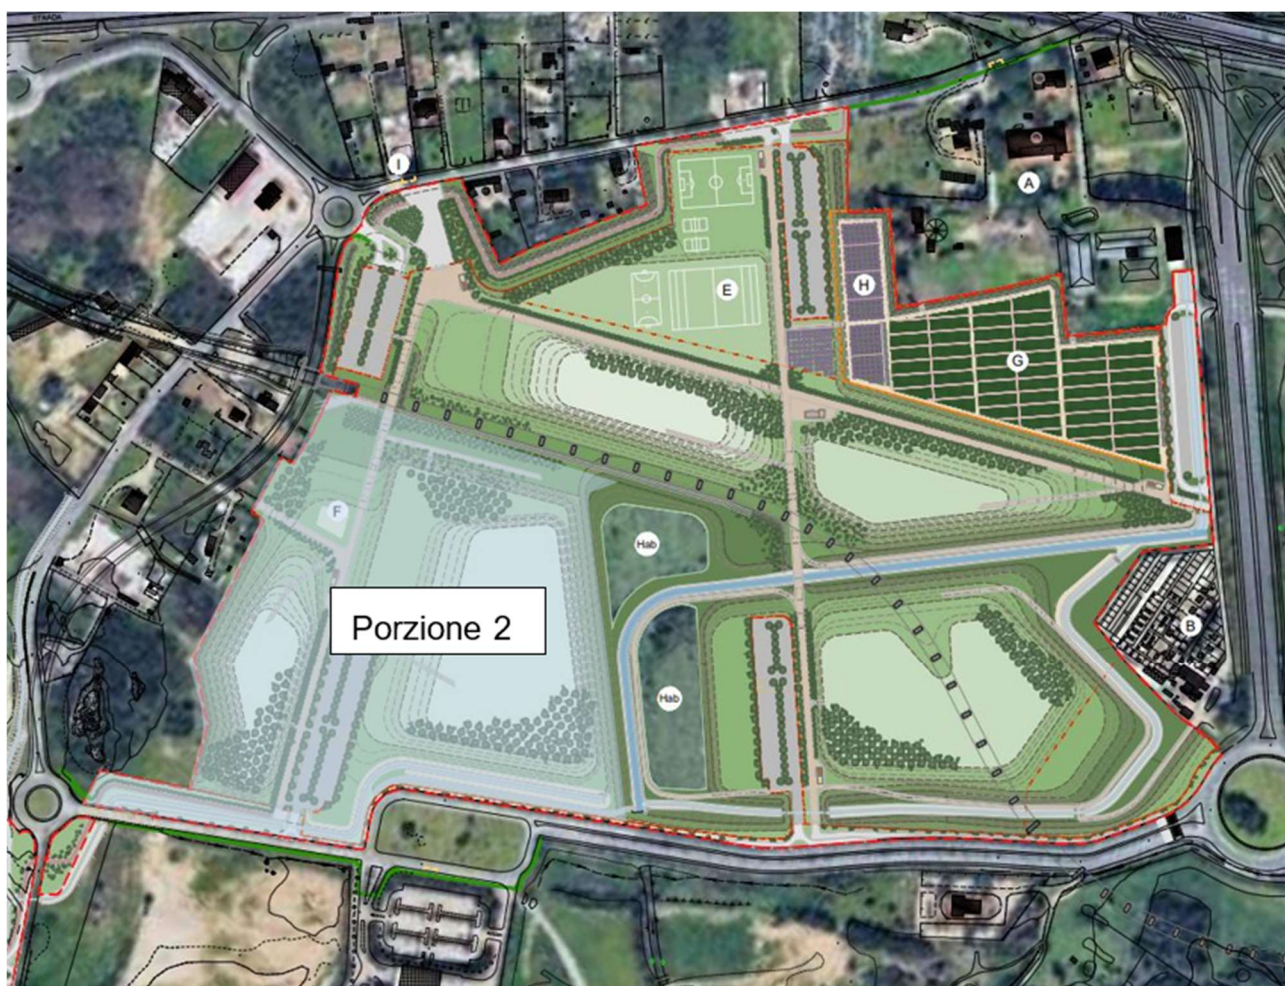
Porzione 2 del cantiere B) di Colcò
